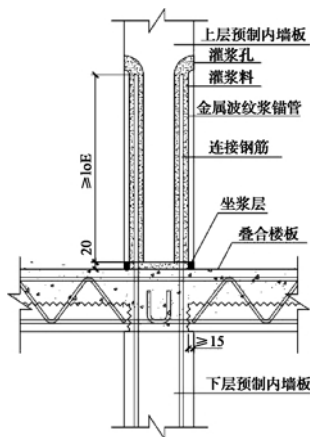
内墙板竖向钢筋分布式约束搭接连接示意图
